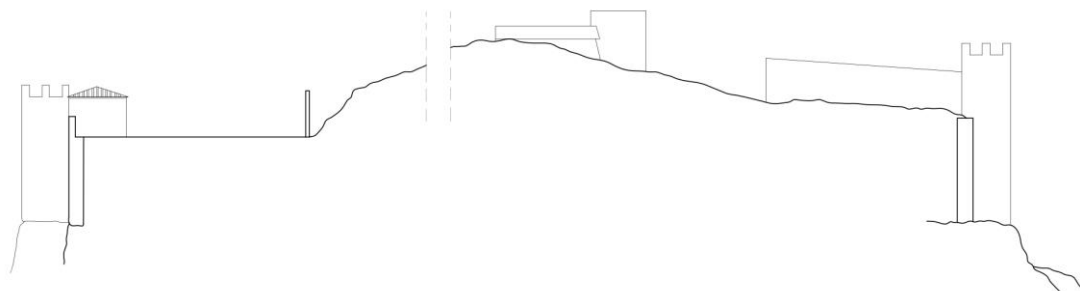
Sección transversal Norte-Sur. Escala 1/500. Fuente: Autora.
